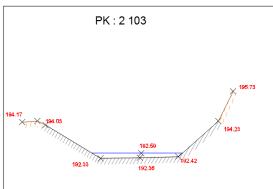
Sections du canal au niveau de la surverse en amont du tunnel du Servant
